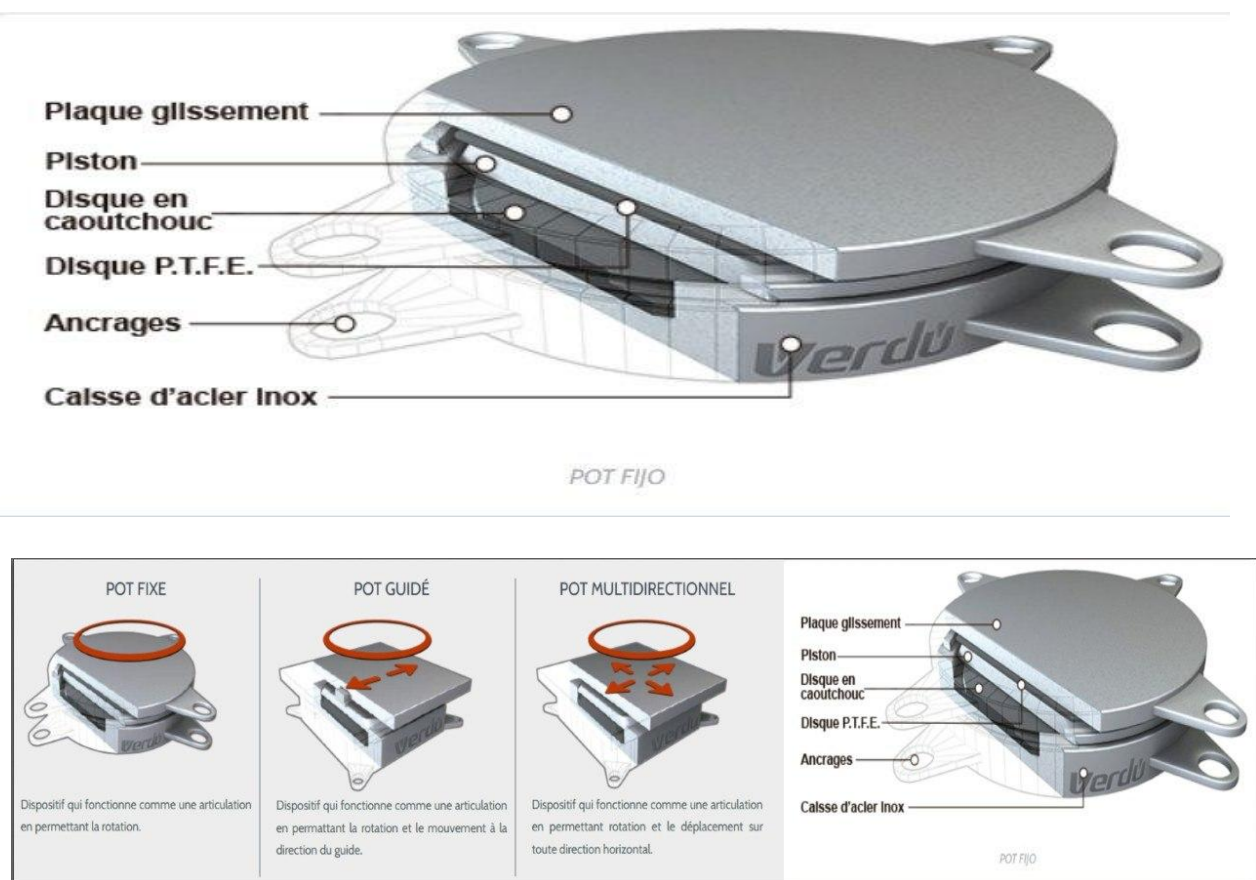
Schéma d'un appareil d'appui a pot.
